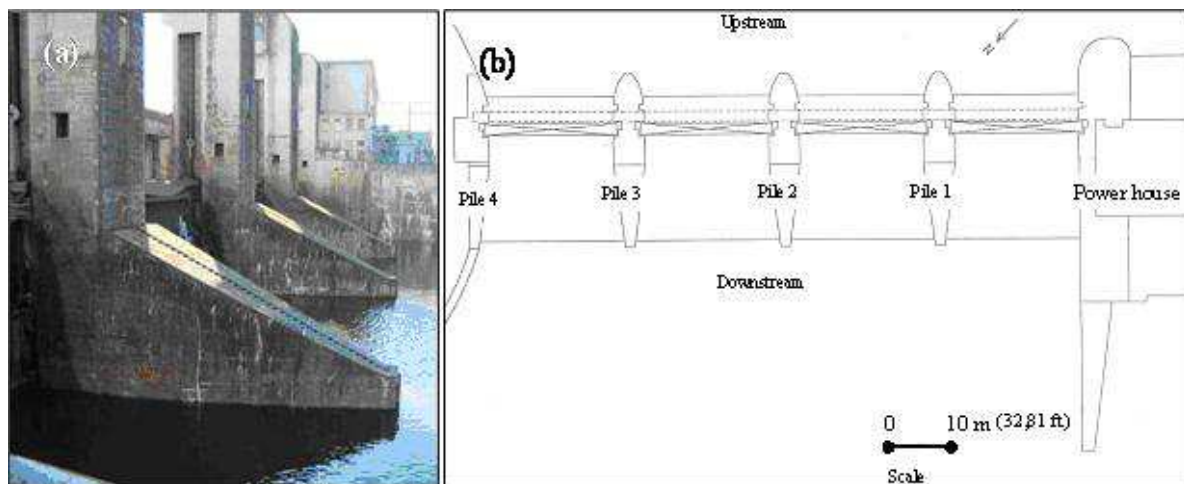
Piles d'un barrage au fil de l'eau (a) et plan de l'ouvrage (b) (Grimal, 2007)
